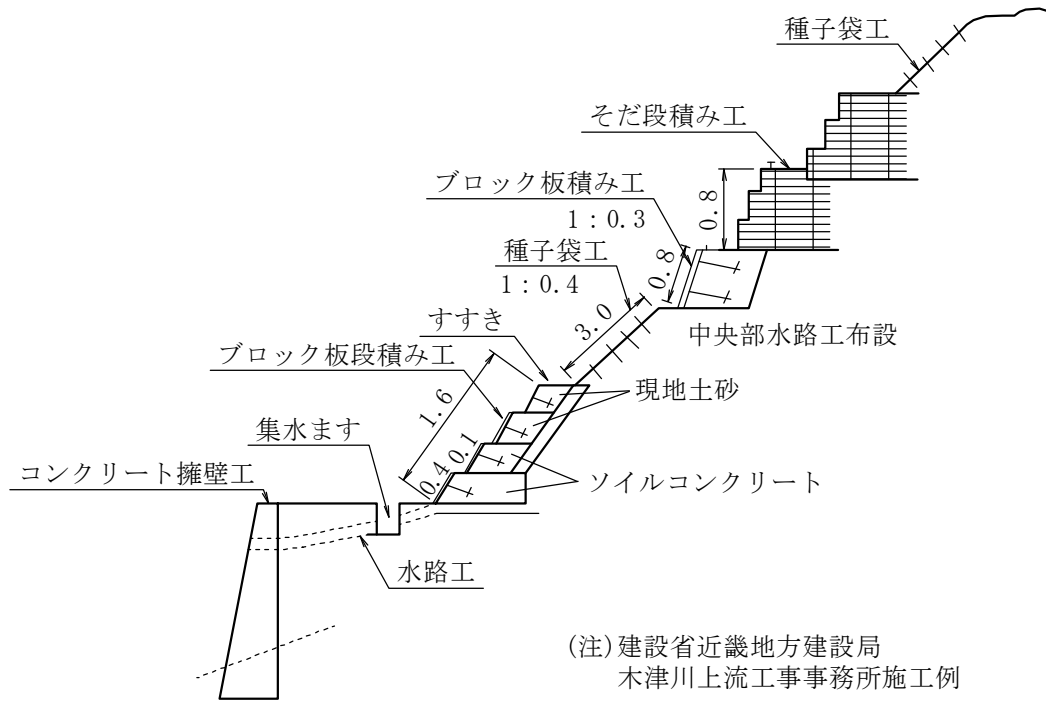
崩壊地（施工例）断面図（単位：m）
